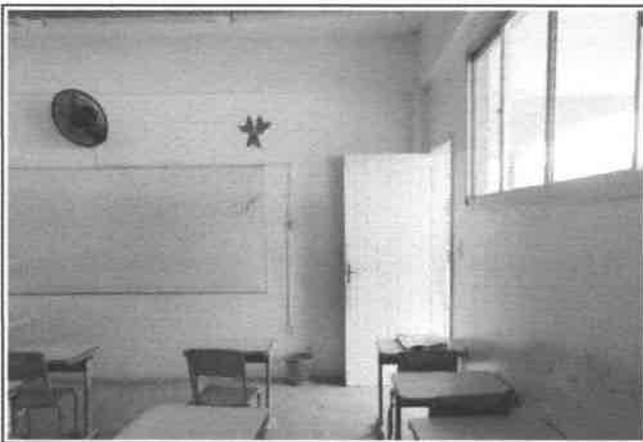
REVESTIR PAREDES SALAS DE AULA BLOCO ANEXO
